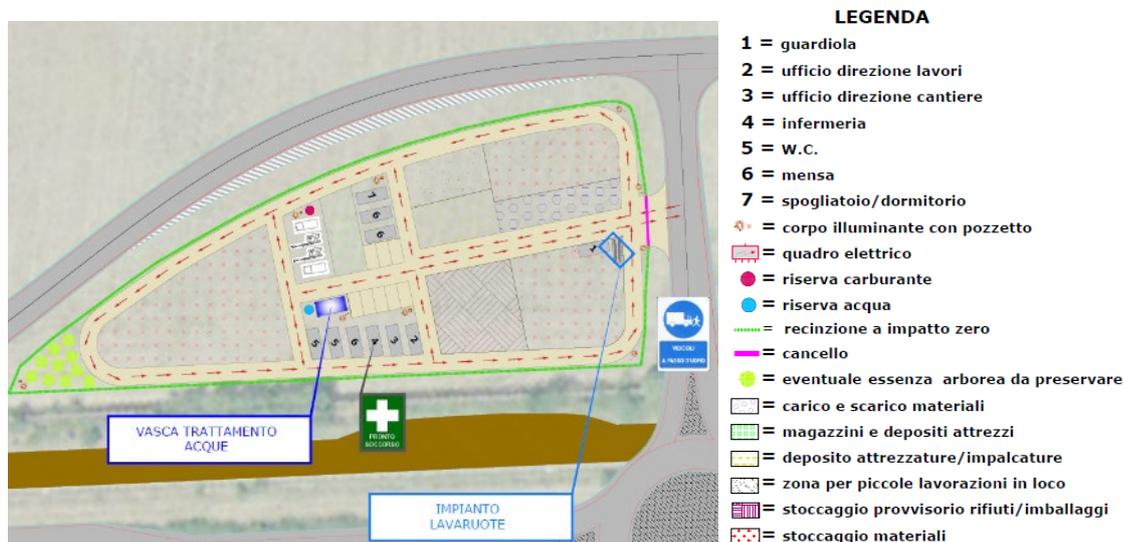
LAYOUT DEL CAMPO BASE PRINCIPALE
